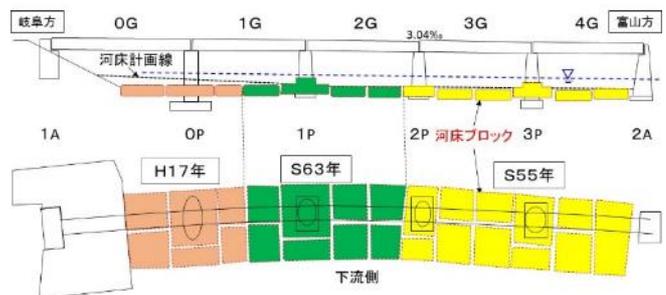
台風被害復旧後の構造概要図(上:側面図、下:平面図)
